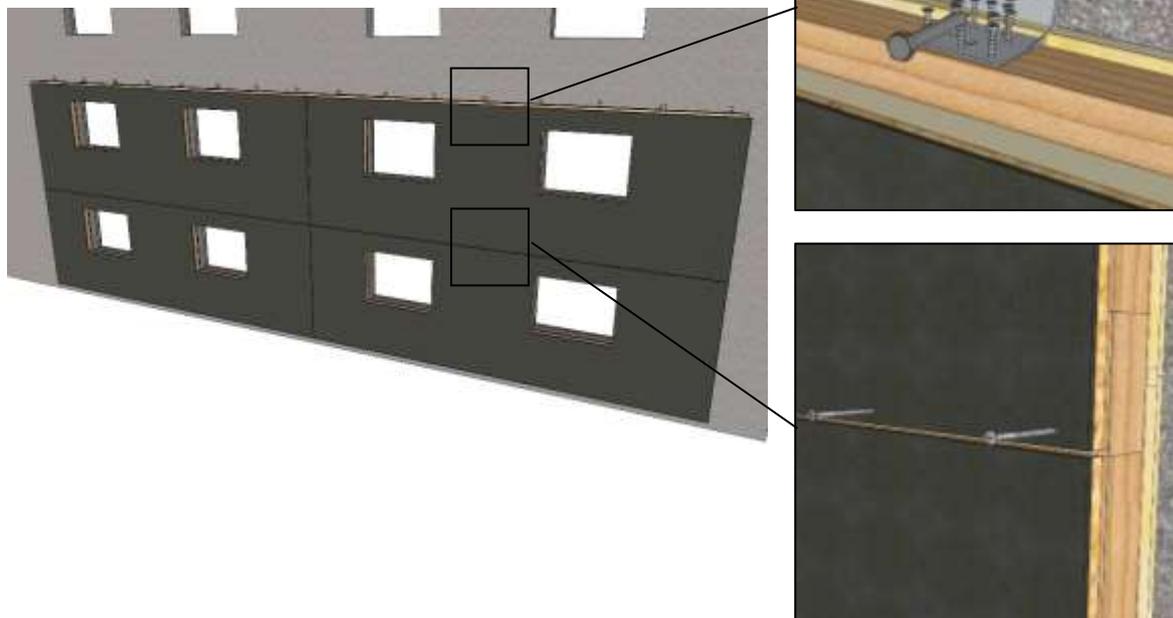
Pose des panneaux sur les panneaux du niveau inférieur. Mise en œuvre des équerre de fixation haute, réglage de l'aplomb du panneau et vissage définitif du panneau – Mode de pose 1
